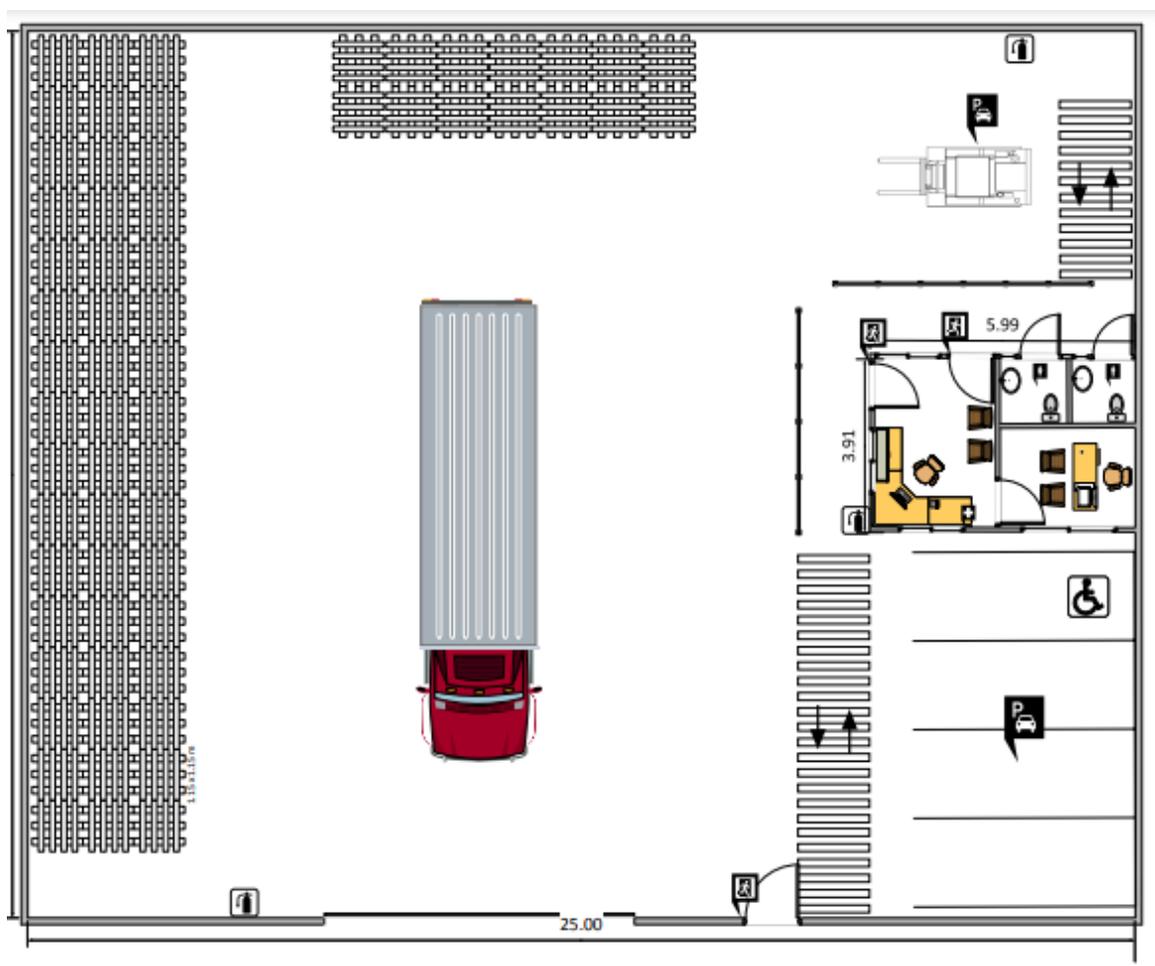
Plano de distribución de planta. Fuente: elaboración propia
